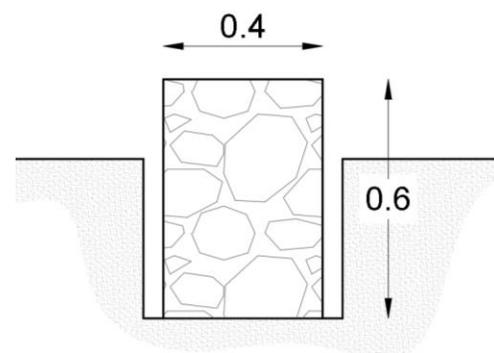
Elaboración de cimientado. Fuente: Elaboración propia
